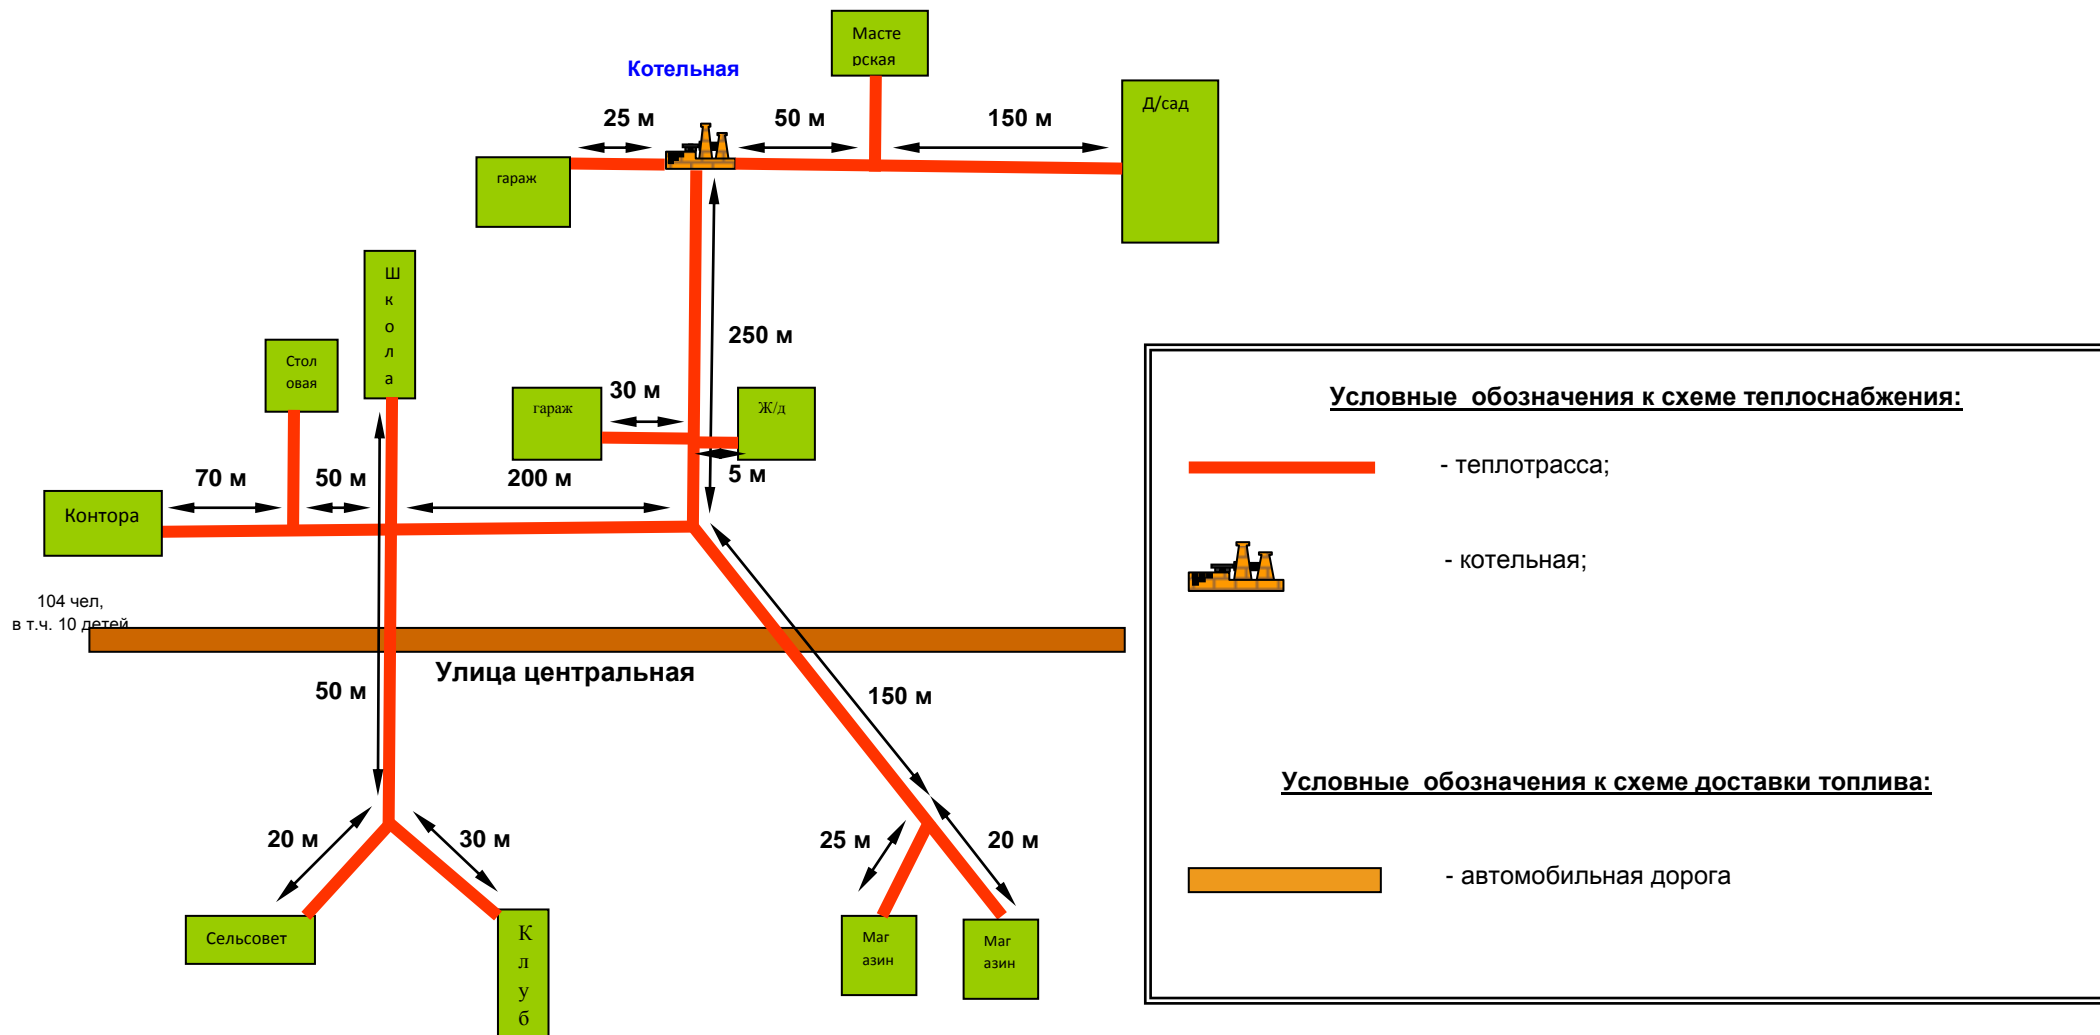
Схема теплоснабжения от муниципальной котельной
